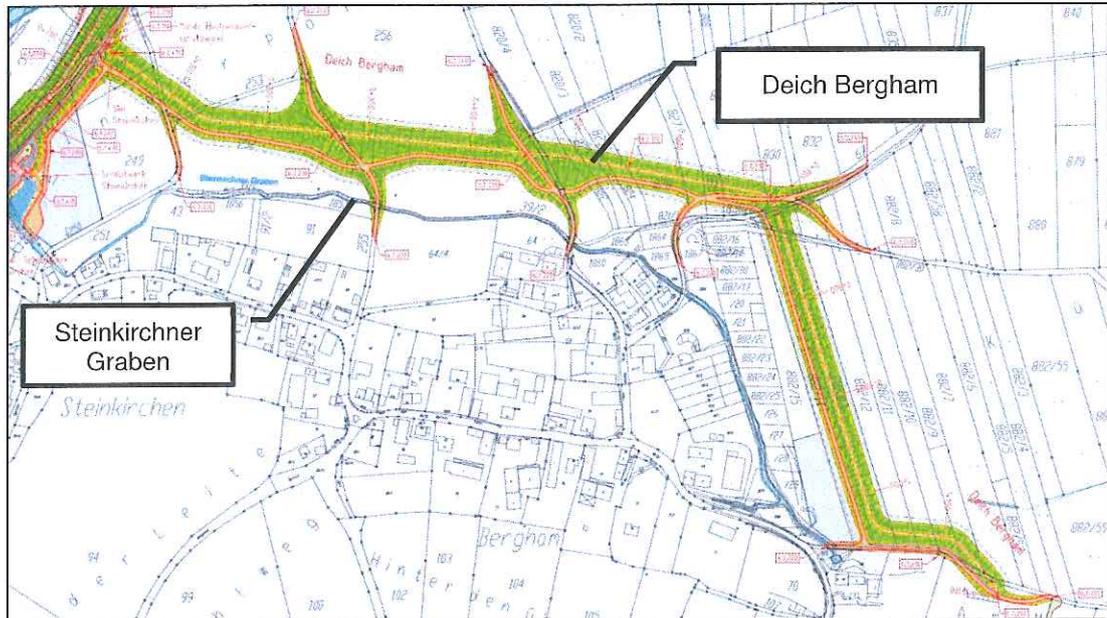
Lageplan Deich Bergham (Ausschnitt aus Beilage 24 der PV-Unterlagen)
